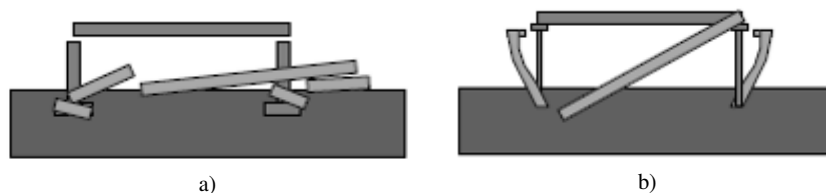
Esquemas de colapso de pontes: a) originado por problemas nas fundações; b) originado pela rotura por corte dos pilares (Kawashima 2009).
